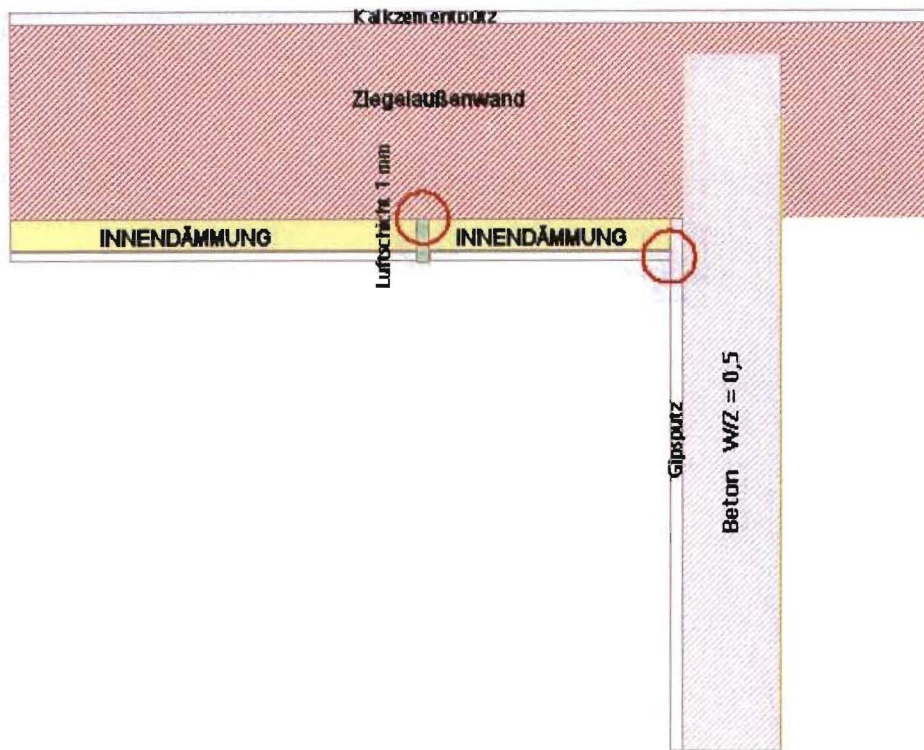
Implementierter Wandaufbau mit einer Betondecke, die 30 cm in die Außenwand einbindet.
